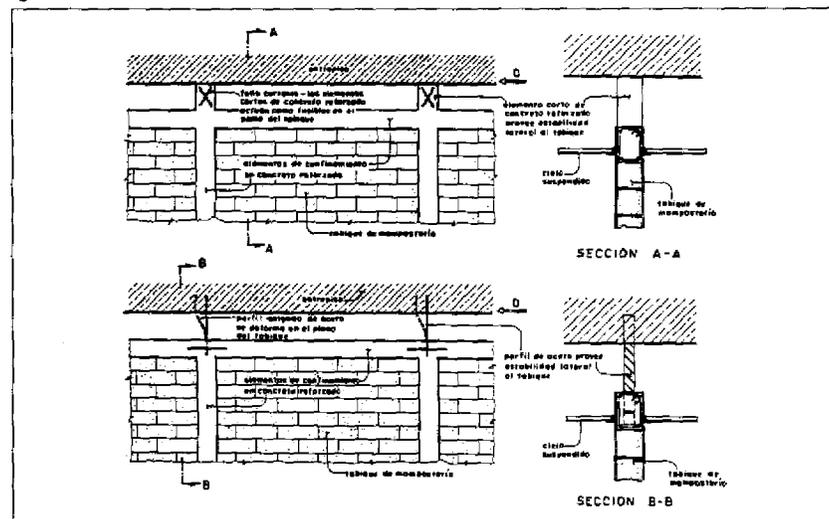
Detalles constructivos tendientes a separar los tabiques del entrepiso superior y a proveer a la pared estabilidad lateral en sentido perpendicular a su plano.
